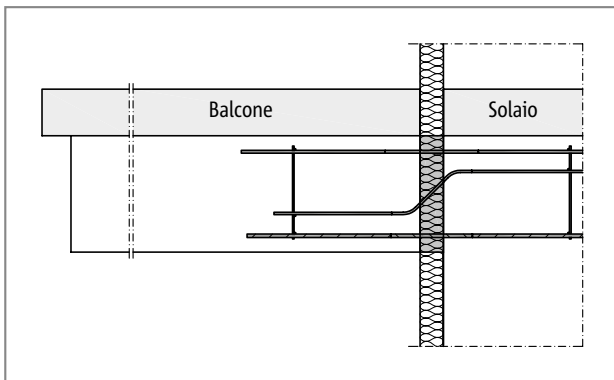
Schöck Isokorb® tipo S, balcone con travi a sbalzo (balcone prefabbricato)
